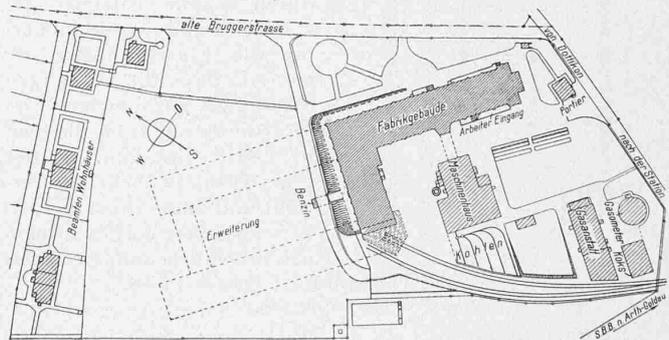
Lageplan der Fabrikanlage. — Masstab 1:3000.
